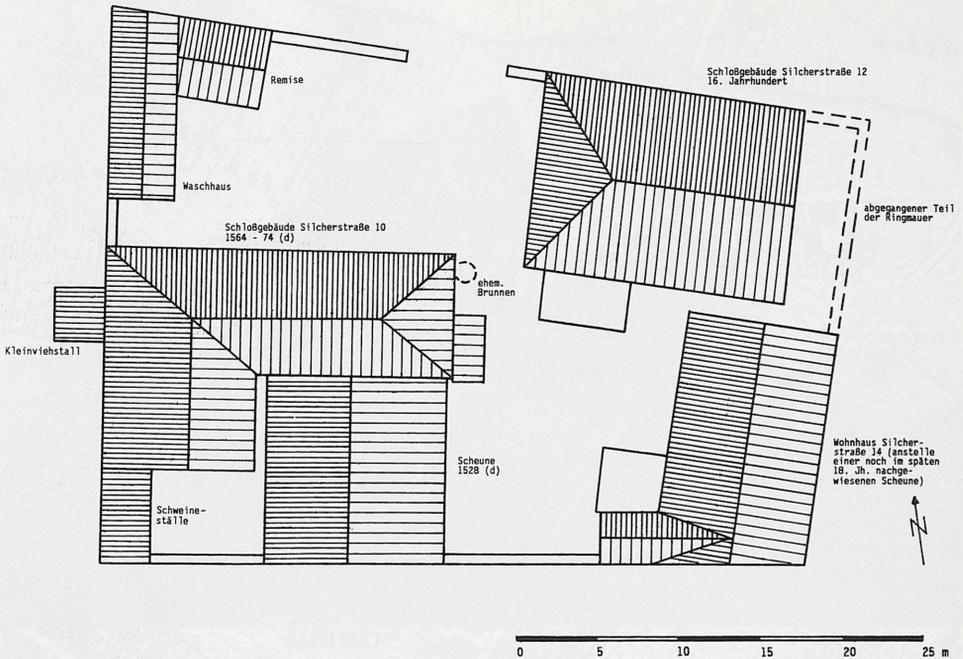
Schnait, Lageplan des Unteren Schlosses.
